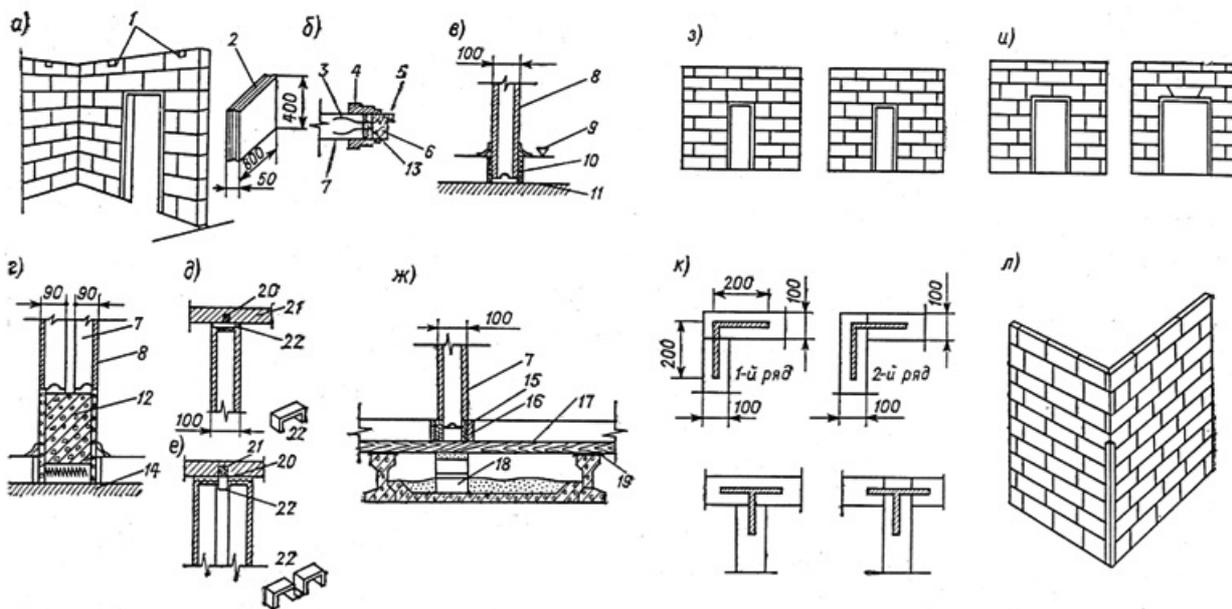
Общий вид перегородок из мелкогабаритных гипсовых, гипсовлажковых и шлакобетонных плит
